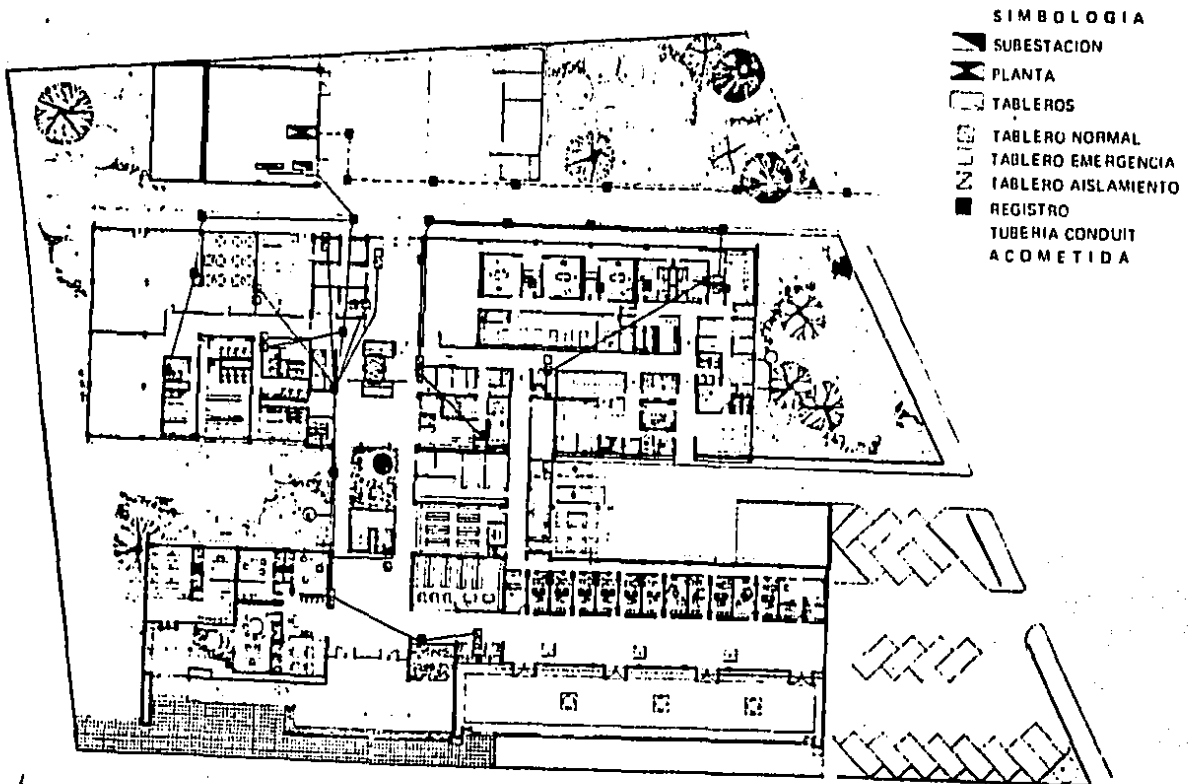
Planta Arquitectónica de Hospital General de Zona con Instalación Eléctrica.
